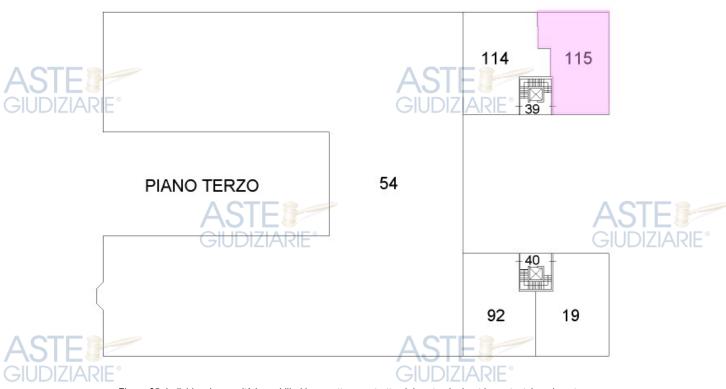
Individuazione unità immobiliari in oggetto su estratto elaborato planimetrico catastale –piano terzo
